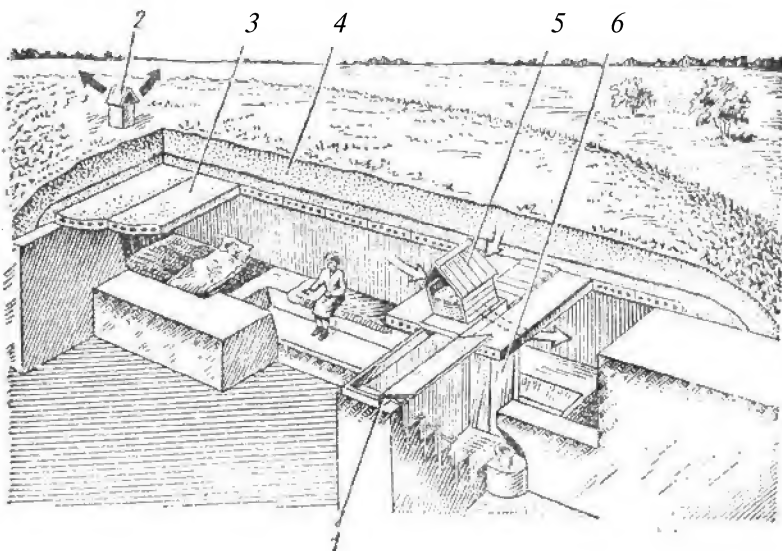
Противорадиационное укрытие с перекрытием из железобетонных плит:
